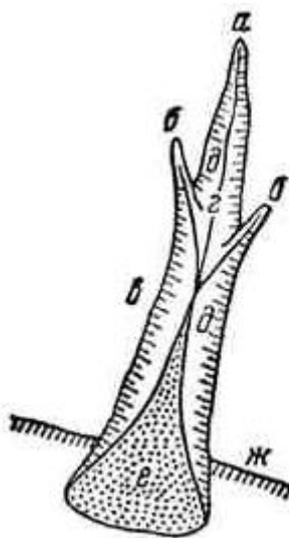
Схема оврага: а – вершина; б – откосы; в – бровка; г – тальвег; д – откосы; е – конус выноса; ж – бровка балки.
